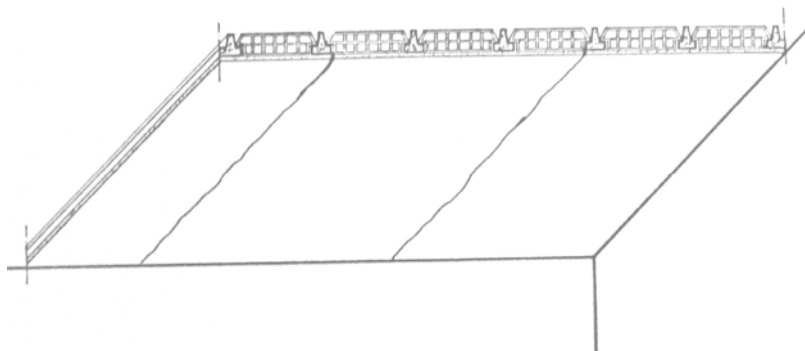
Fissuras provocadas por movimentações térmicas em forro constituído por laje mista
